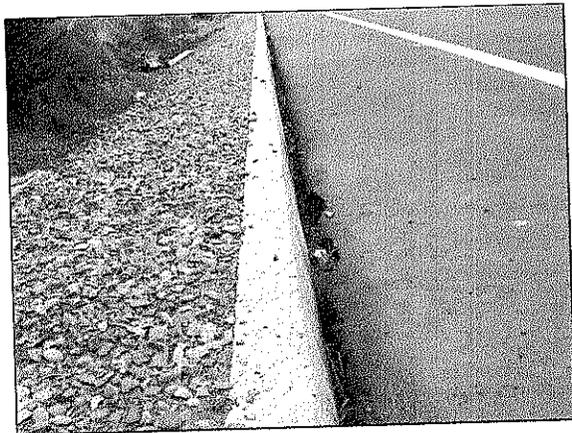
Fisura en acera producida por instalación de poste de alumbrado en acceso puente Pumalal.
